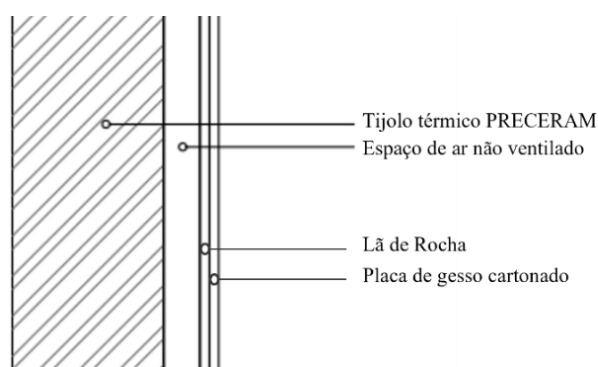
Pormenor construtivo da Parede Exterior PE1.
